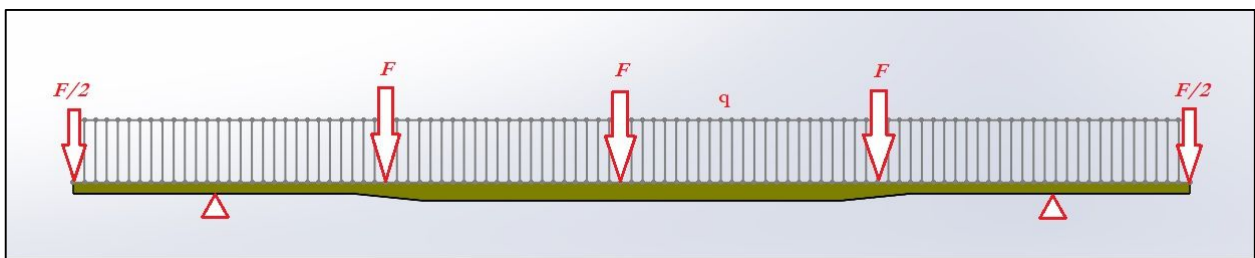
Cargas aplicadas sobre vigas principales lateral.
